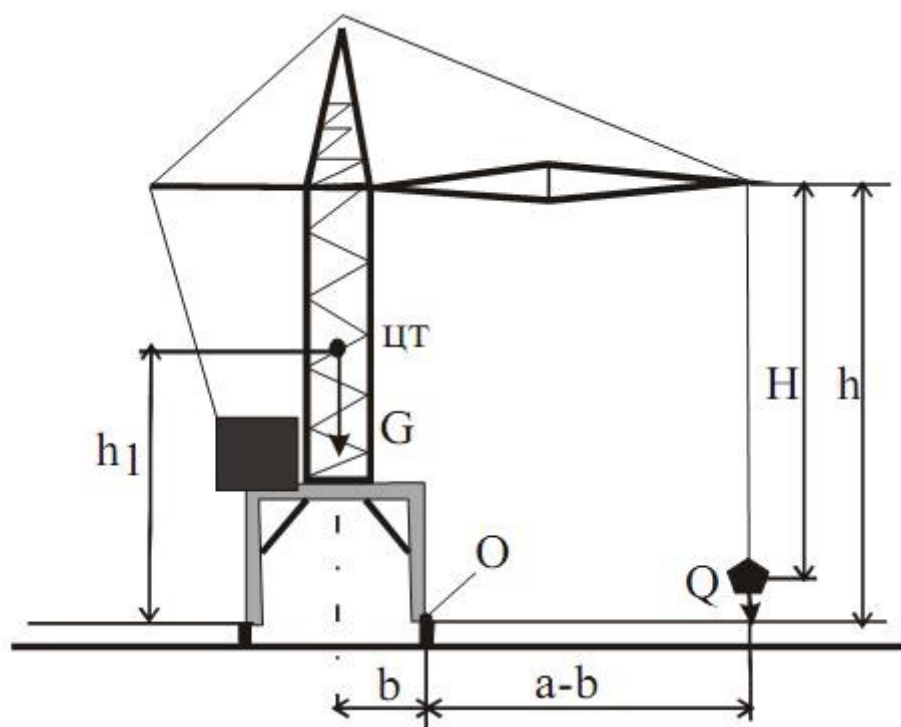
Расчётная схема грузовой устойчивости башенного крана:
